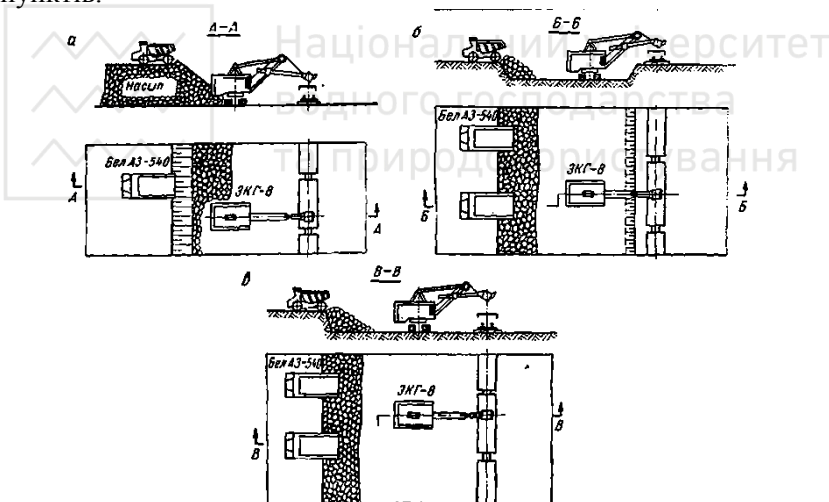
Схеми будови екскаваторних перевантажувальних пунктів
